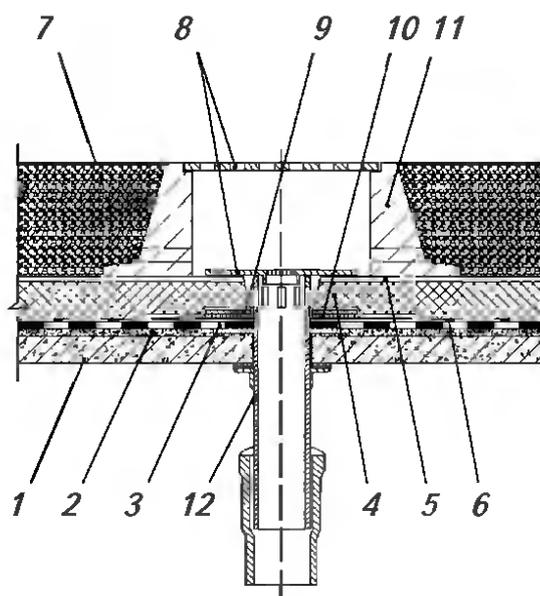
Схема инверсионной кровли: 1 – железобетонная плита, 2 – выравнивающая стяжка, 3 – кровельный ковер, 4 – теплоизоляция, 5 – предохранительный слой, 6 – точечная теплоизоляция, 7 – пригруз, 8 – защитная решетка, 9 – прижимной фланец, 10 – герметизирующая мастика, 11 – бортовой камень, 12 – водоприемный сток.
